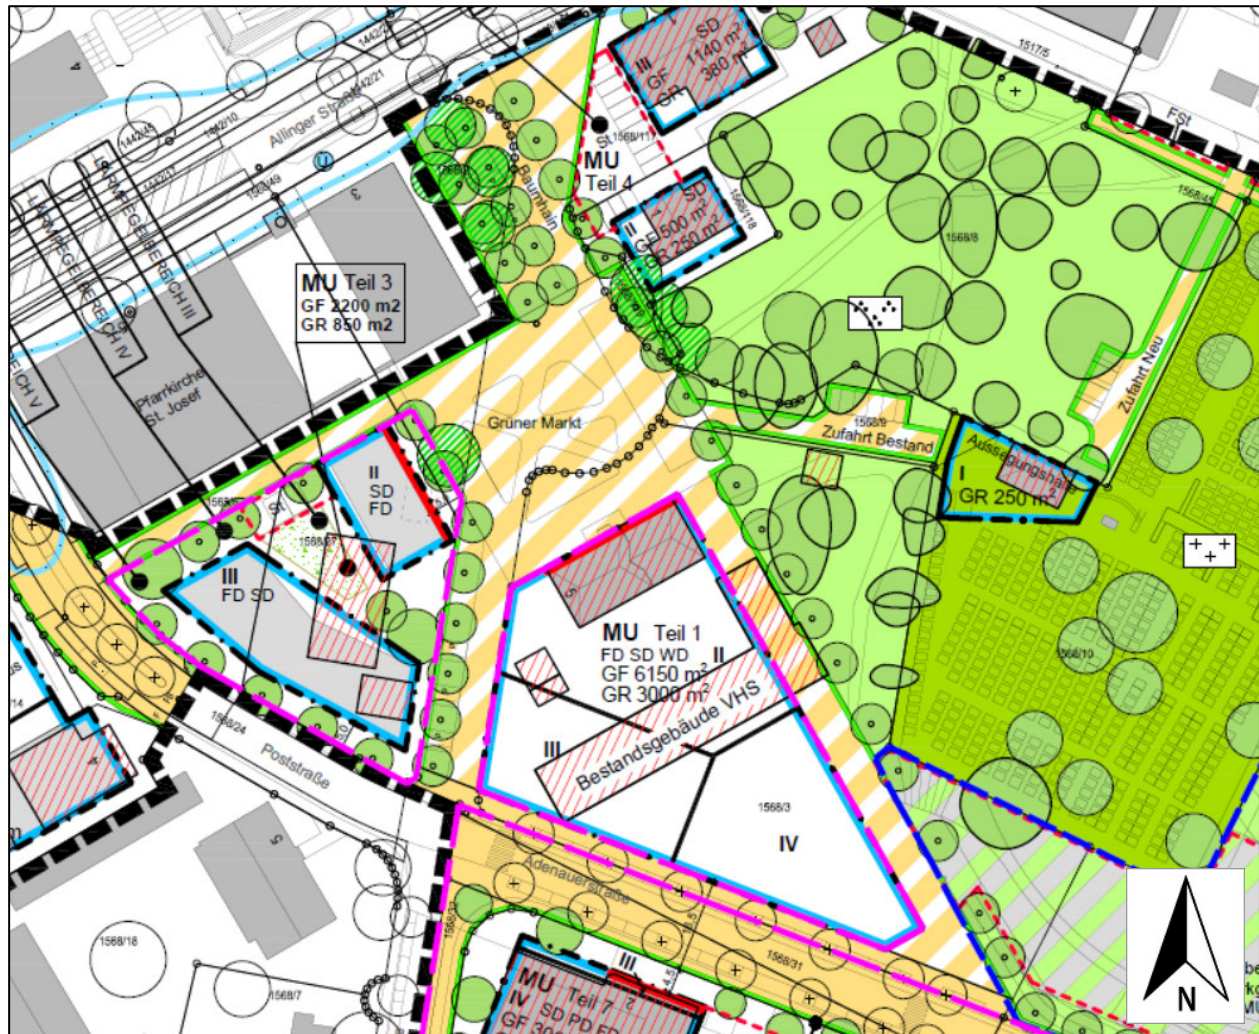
Planausschnitt (Quelle /1/): Verkehrsflächen mit vermutlich gegenwärtig noch vorhandenem Planiematerial. Kein spezieller Maßstab.
